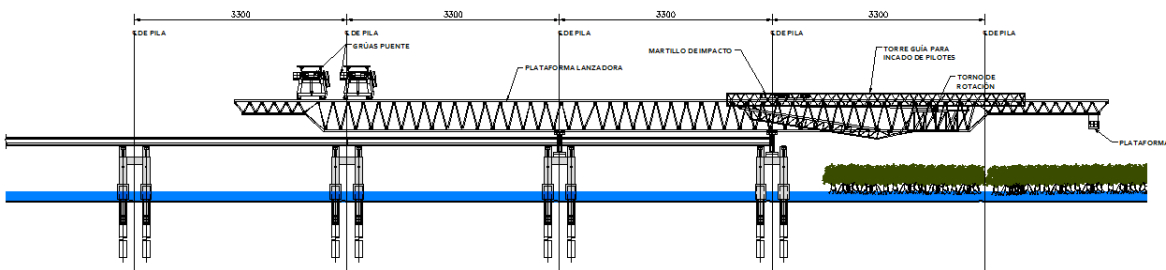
Hincado de Pilotes en zona de Manglar
